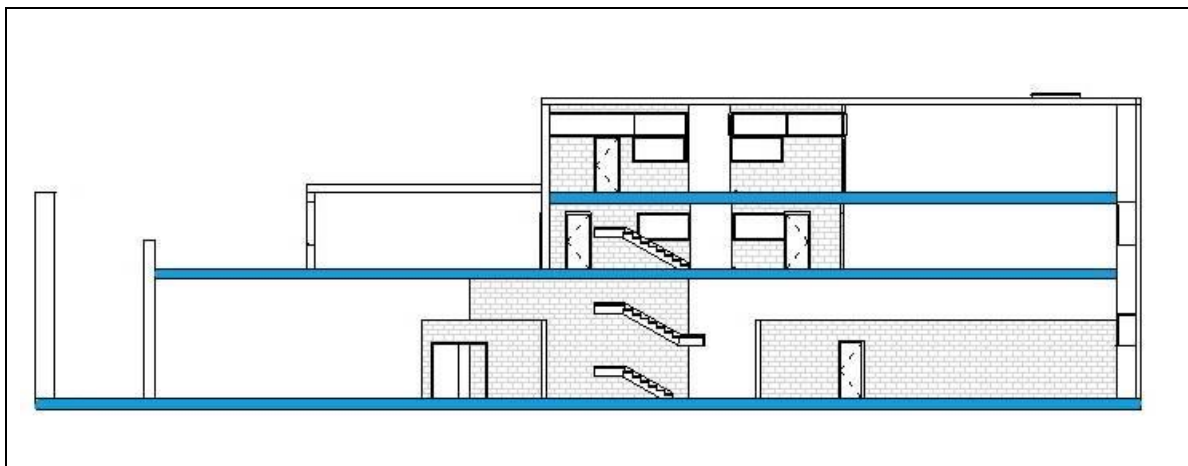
Grafiado planta y alzado particiones interiores
